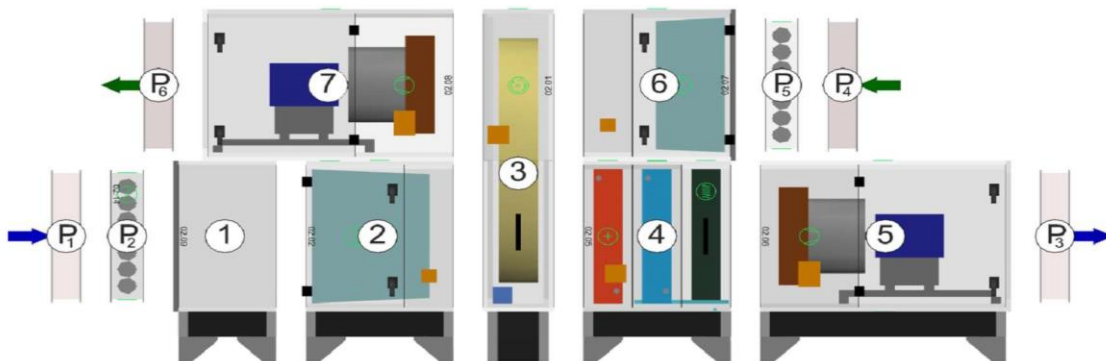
VZT jednotka č. 2 bokorys + půdorys
